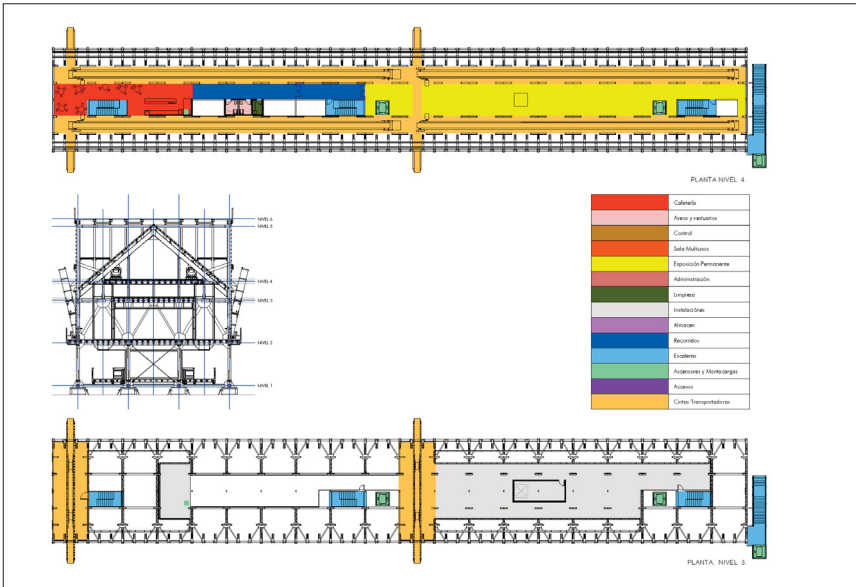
Plantas niveles 3-4, Almería, 2009. Elaboración propia.
